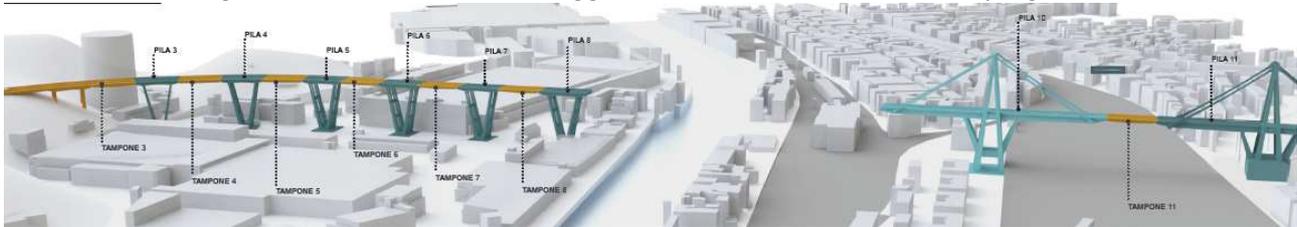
Elementi strutturali oggetto di demolizione (estratto da progetto)
